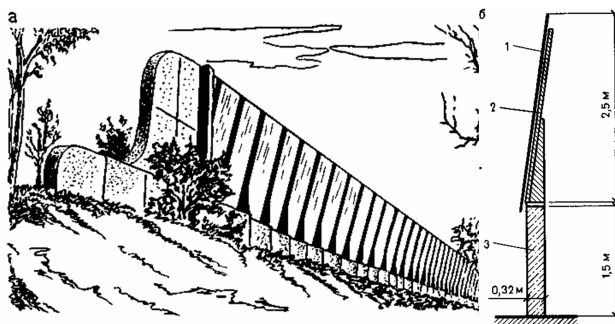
Проект будівельно-акустичного екрану по вул. Хмельницьке шосе, 98 (м. Вінниця): а – загальний вигляд; б – конструктивна схема: 1 – ущільнене скло; 2 – металевий каркас; 3 – бетонна стінка.
